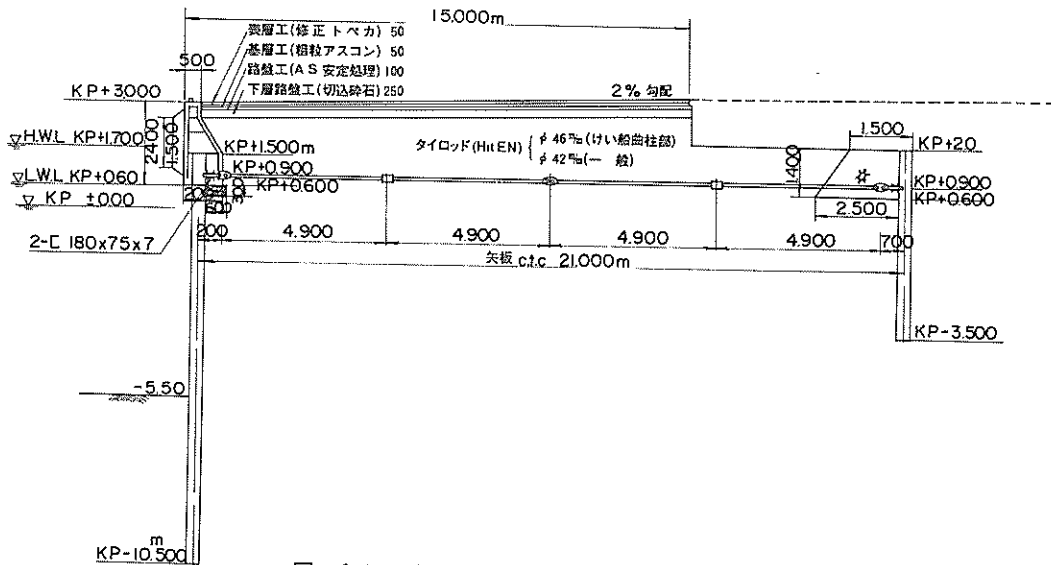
石巻港中島ふ頭 (-5.5 m) 標準断面図
